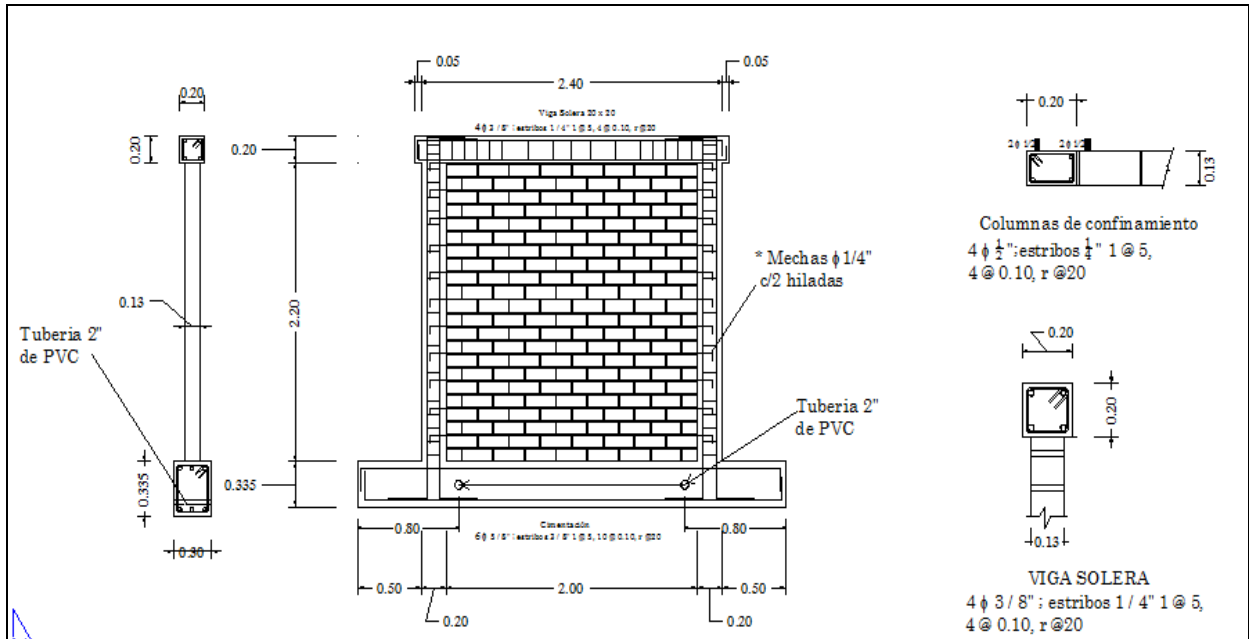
Muro M1, peralte de columnas de 20 cm.
